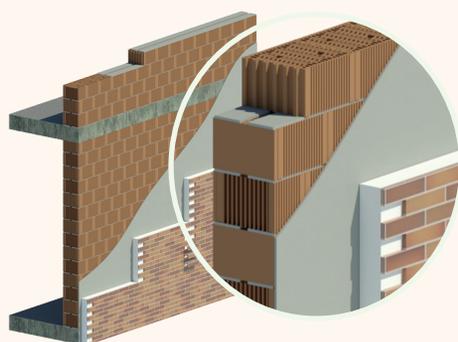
Fachada de bloque cerámico con sistema prefabricado de aislamiento con acabado cerámico
